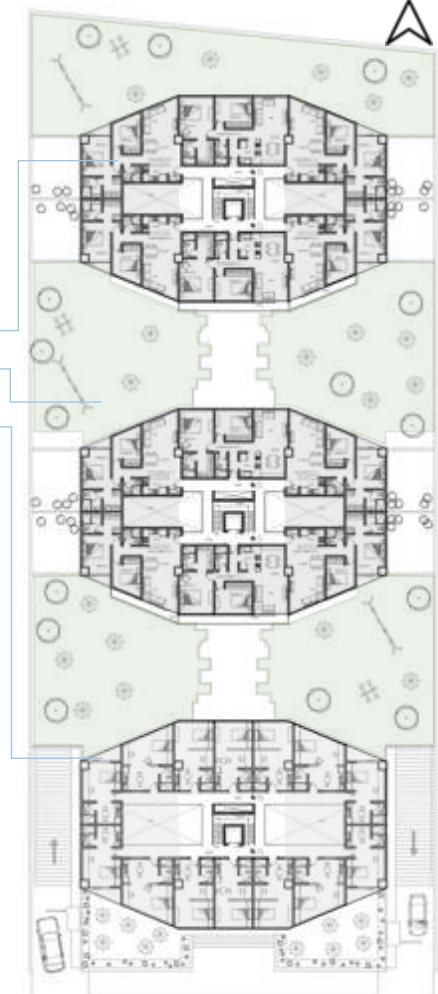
Planta tipo esquemática de conjunto, etapa d.
